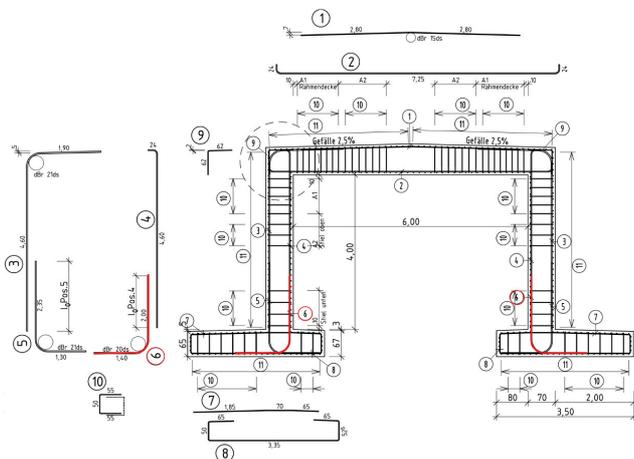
Anwendung der Bewehrungsrichtzeichnung
